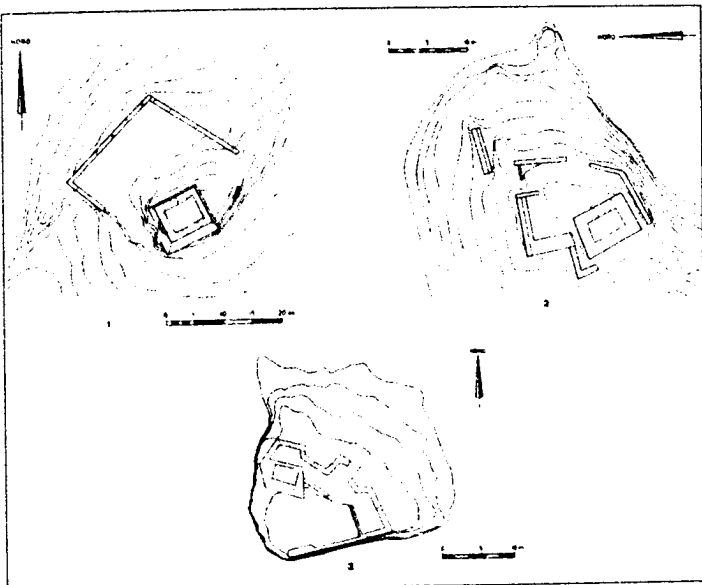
Plantas de las fortificaciones de Benifallim (1), Carrícola (2) y Benimantell/Aguilar (3) Planimetría de J. M.^o Segura
